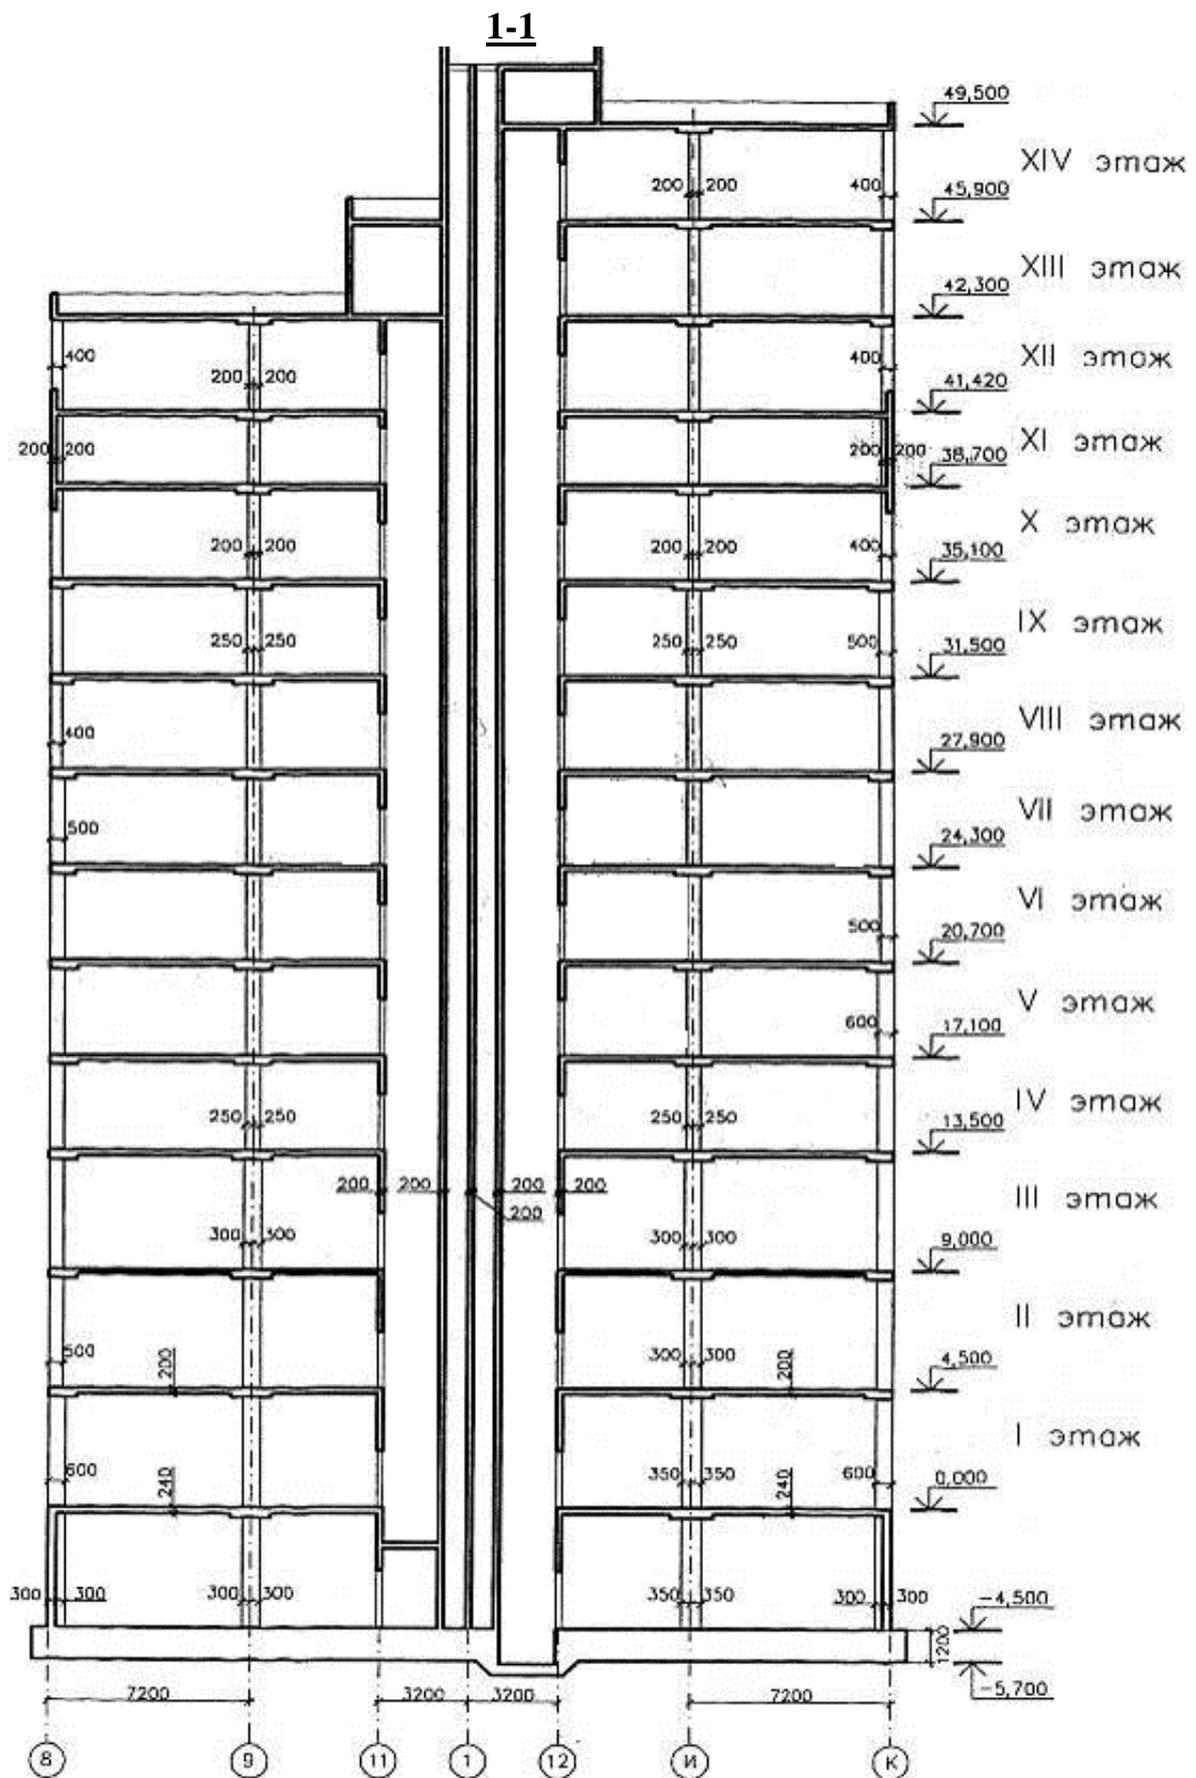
Поперечный разрез 1-1 по 14-этажному каркасному зданию к схеме расчета на предотвращение прогрессирующего обрушения
